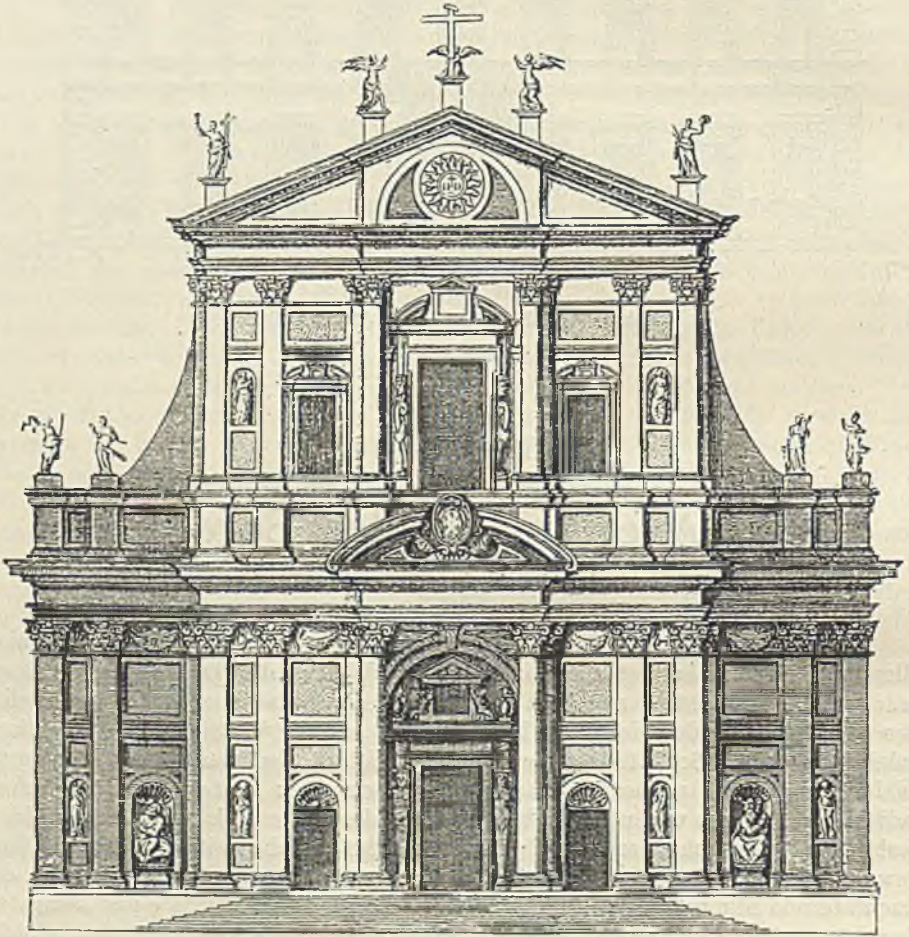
Vignolas Fassadenentwurf für il Gesù
